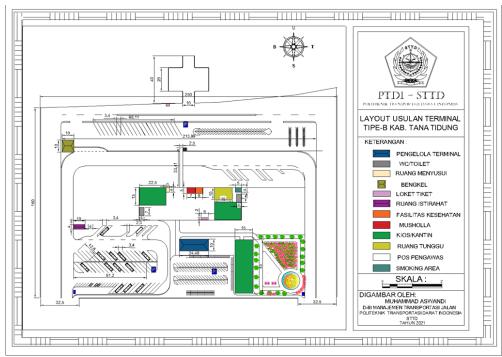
Layout Usulan 2 Fasilitas Terminal tahun dasar (2024)
